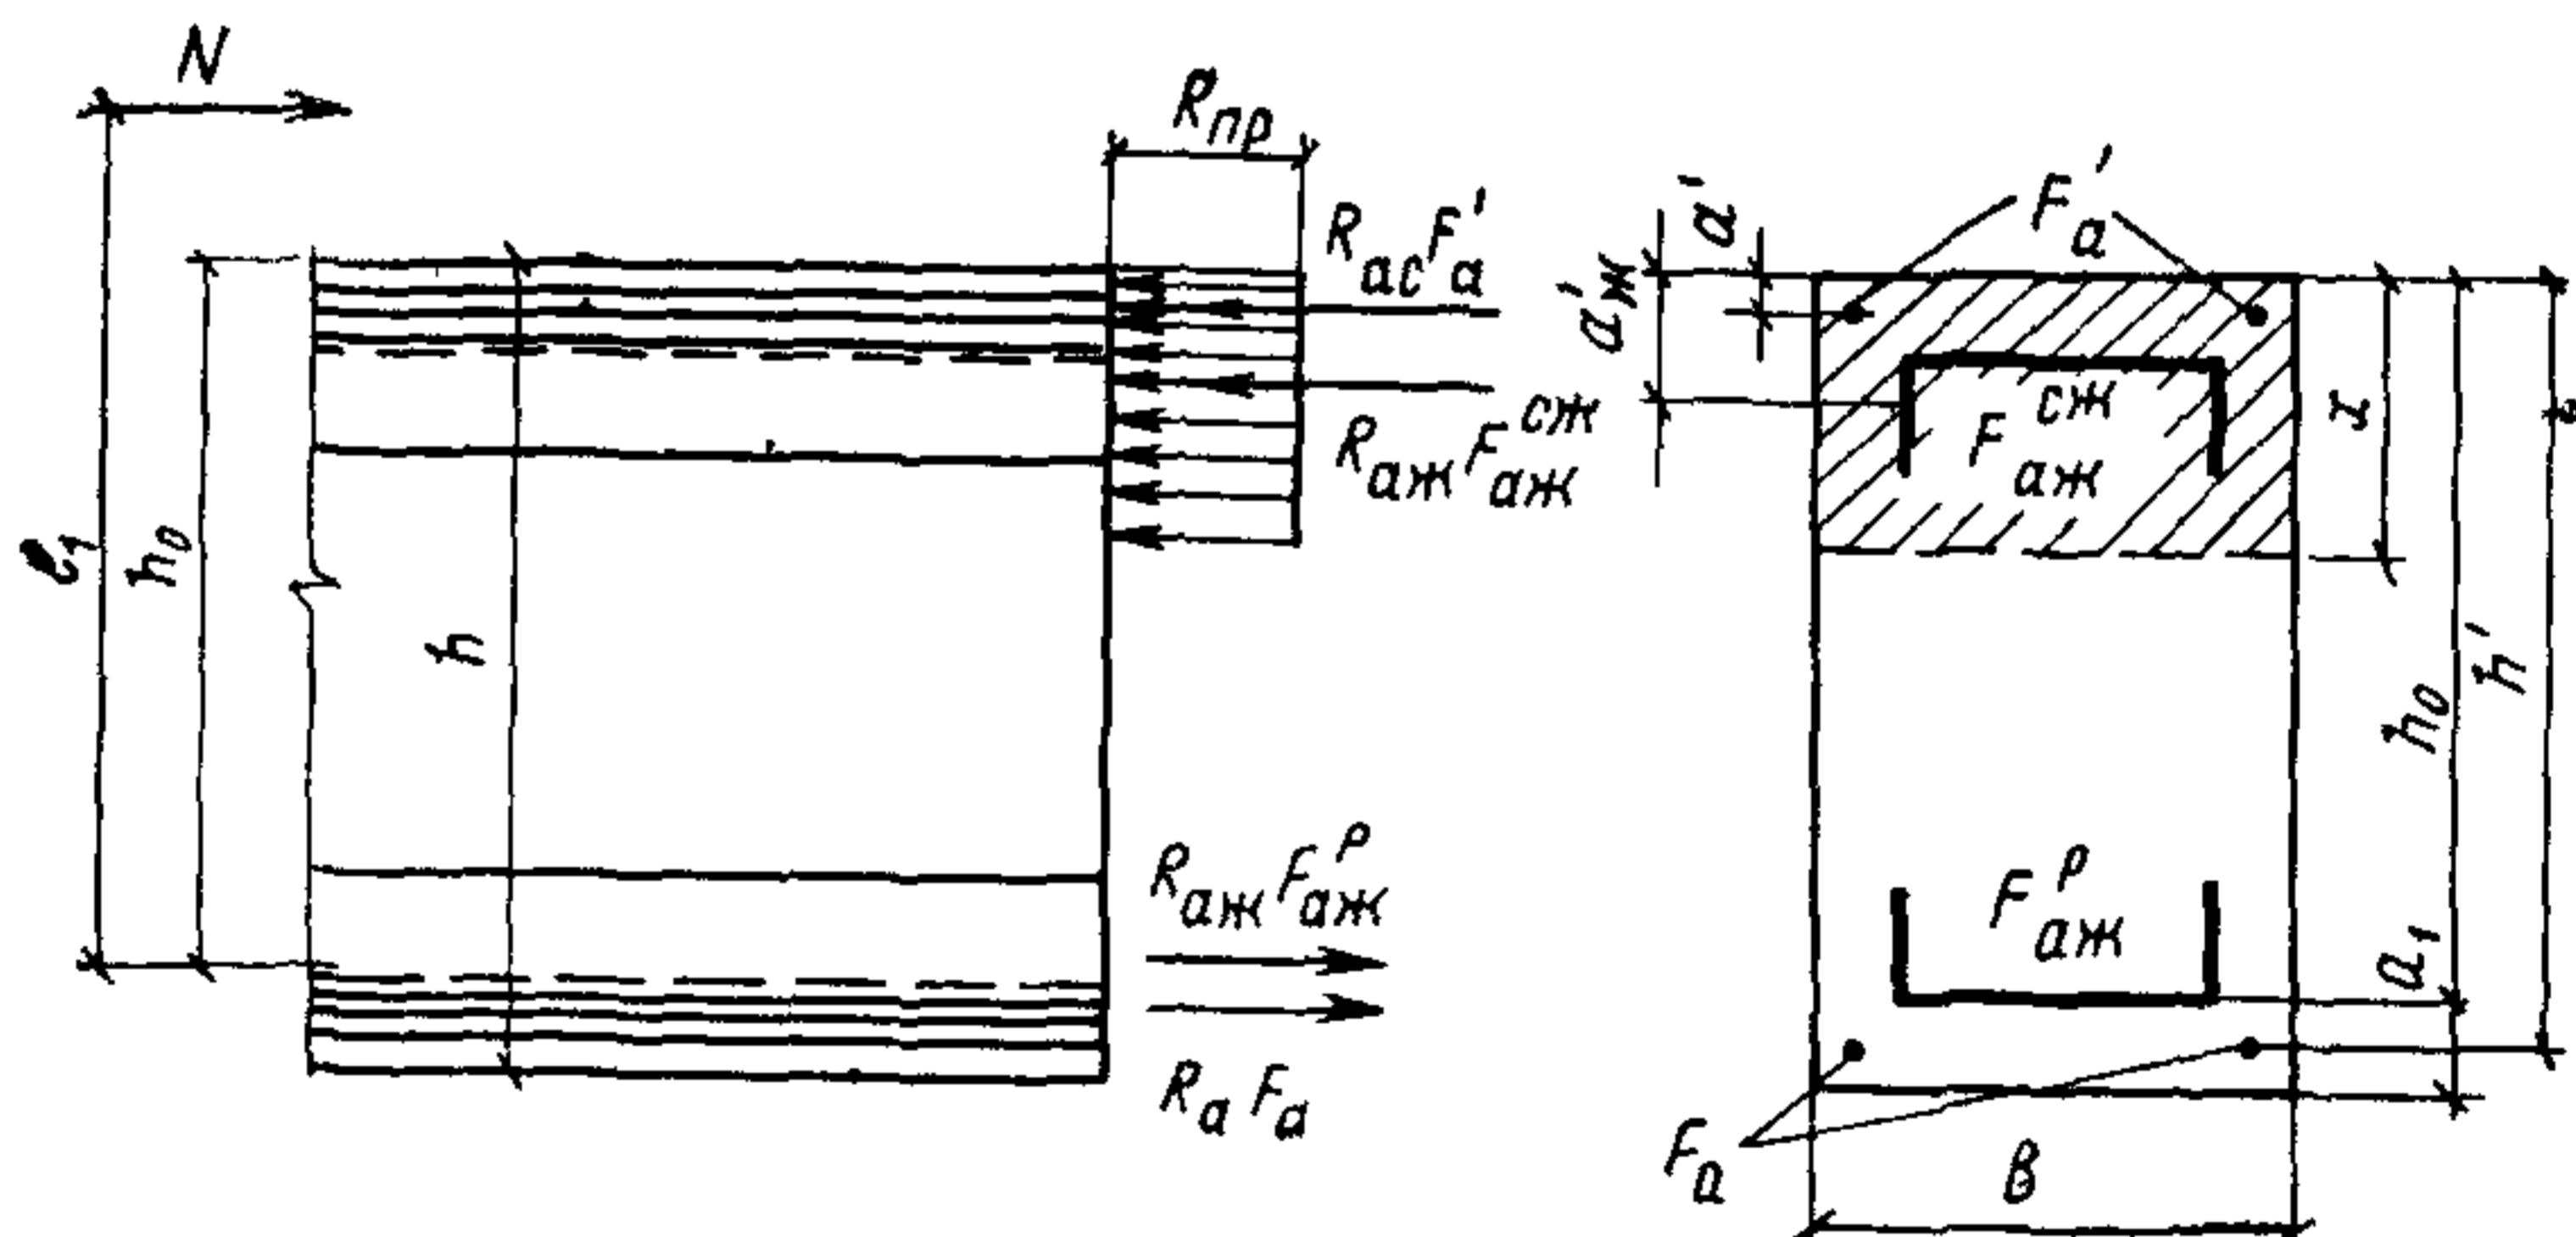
Схема усилий в прямоугольном сечении сжатого элемента с жесткой и гибкой арматурой, сосредоточенной у растянутой и у сжатой граней
